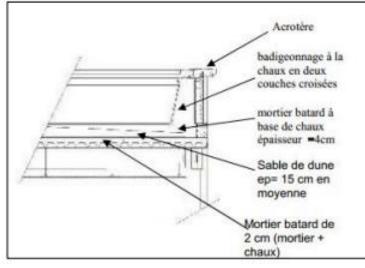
Détails de l'étanchéité. / Sources : auteur
